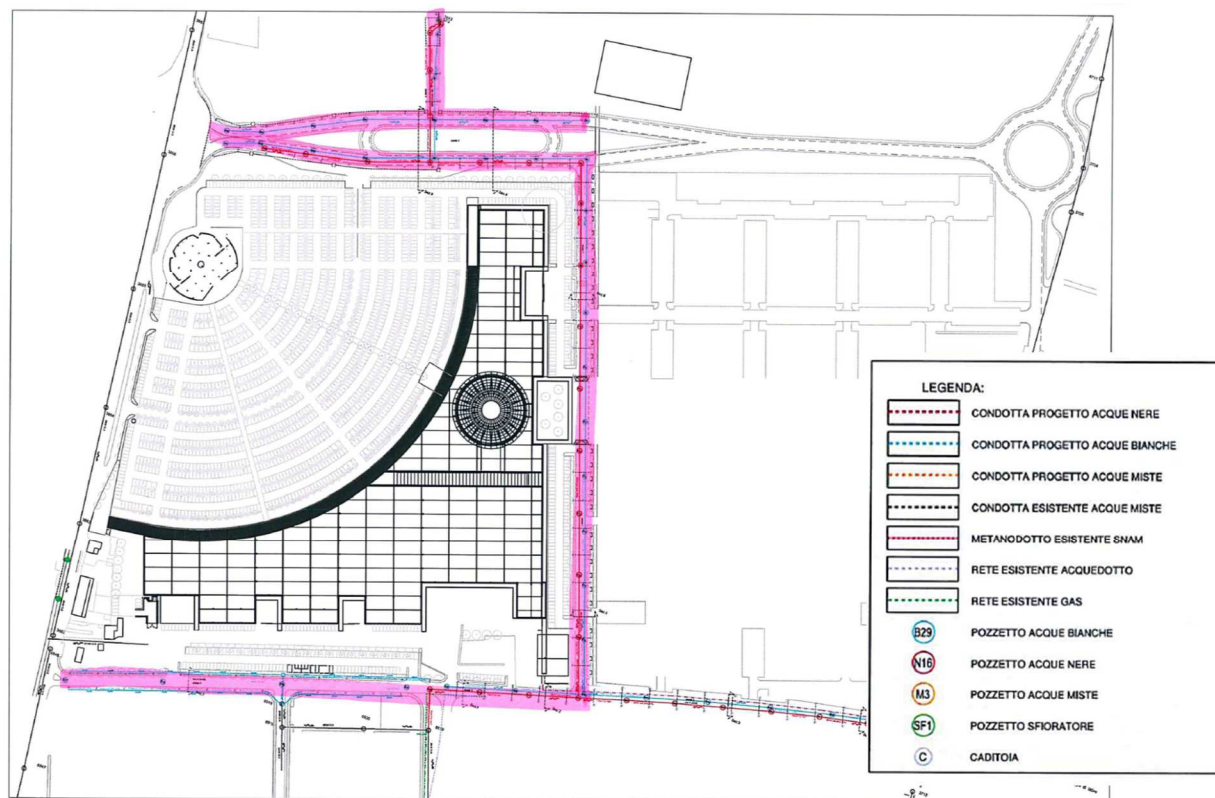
Planimetria rete fognaria acque bianche e acque nere
